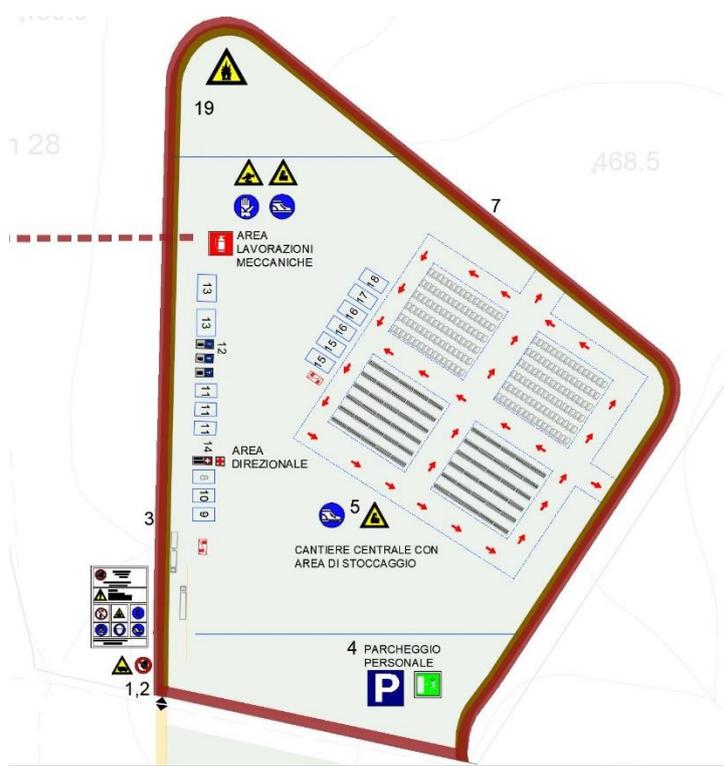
Ricezione, stoccaggio e movimentazione materiali, piastra 1°, cantiere 1
